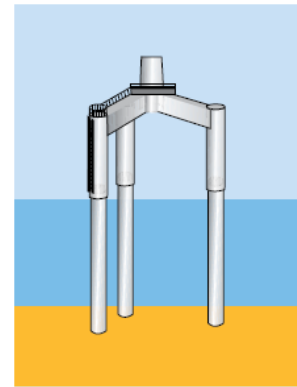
Cimentación tipo tripilote. Fuente: EWEA
